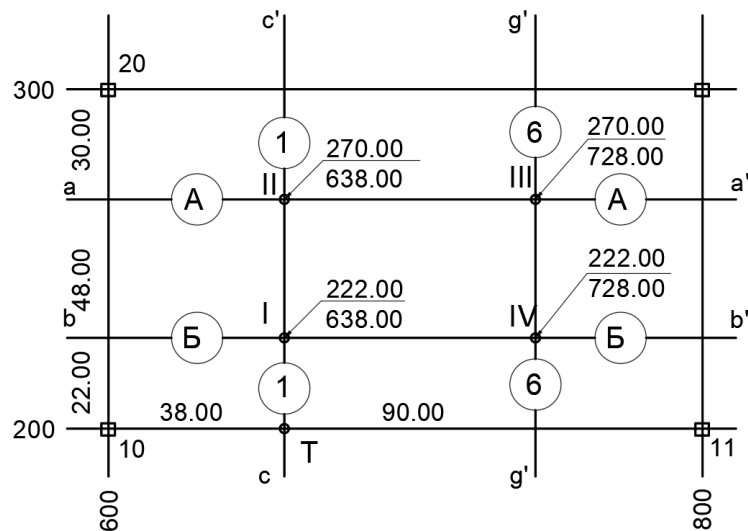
Розбивка споруди від пунктів будівельної сітки
